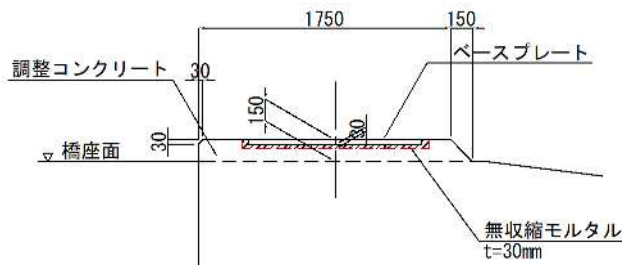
標準的な桁座形状 (要領 図-3.63)
